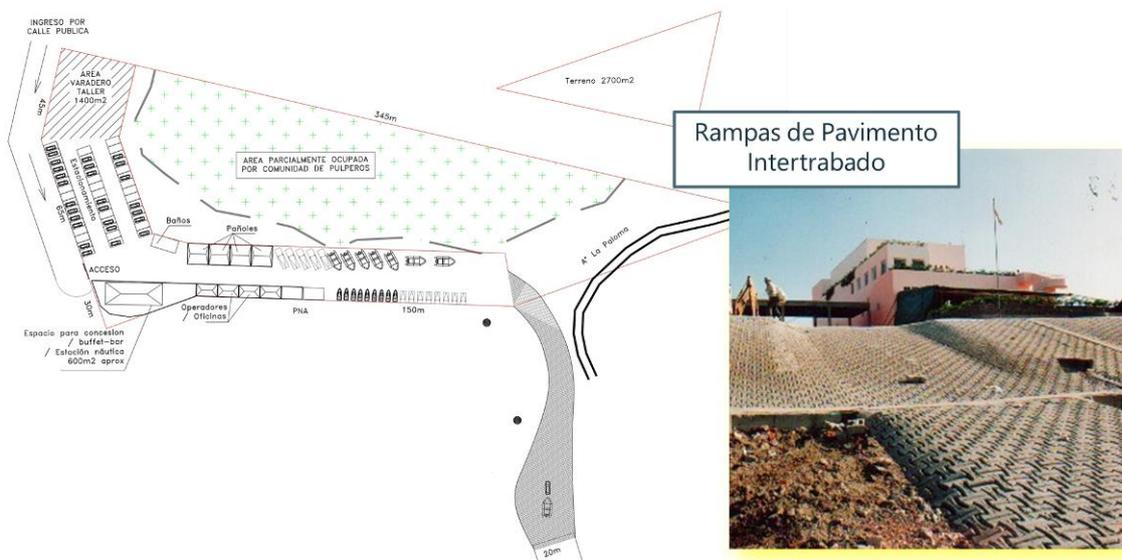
Vista en planta de la rampa de vinculación, y propuesta para revestimiento. Fuente: propia
